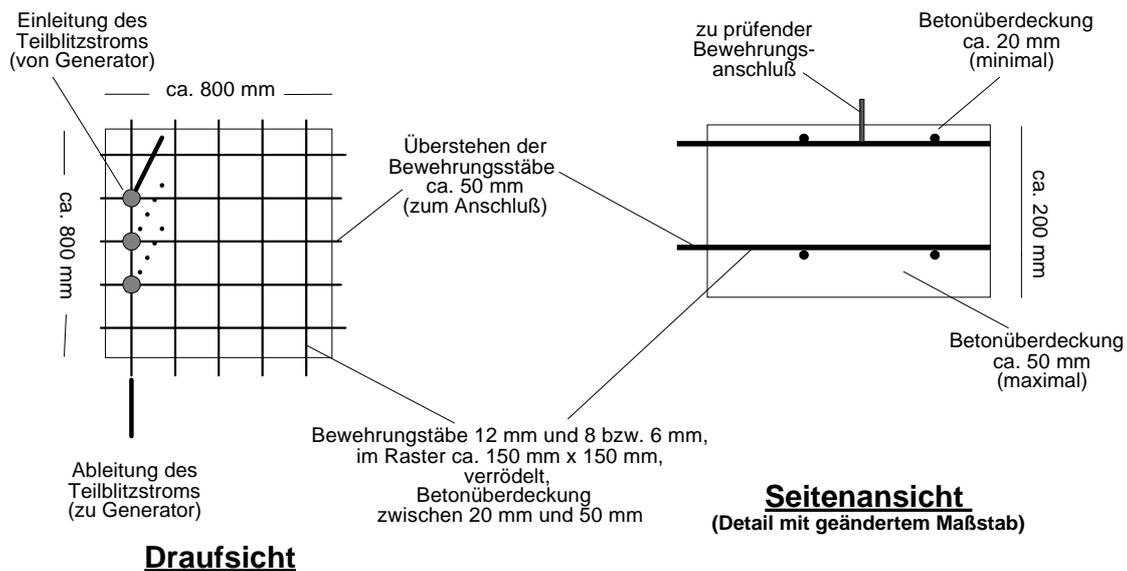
Prüfling Typ B: Betonplatte 800 x 800 mm² mit mehreren Anschlüssen.
